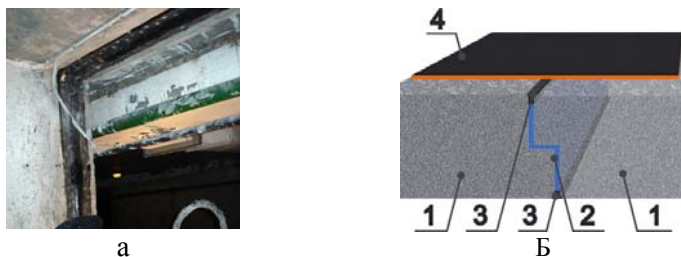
Деформационный шов на бетоне или бетонных плитах:
